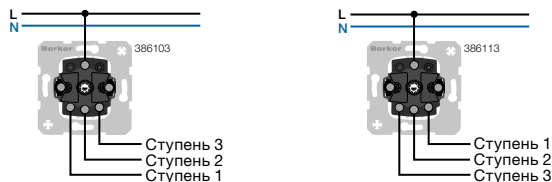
Трехступенчатый выключатель с нулевым положением [№ для заказа 3861 03] / трехступенчатый выключатель без нулевого положения [№ для заказа 3861 13]
